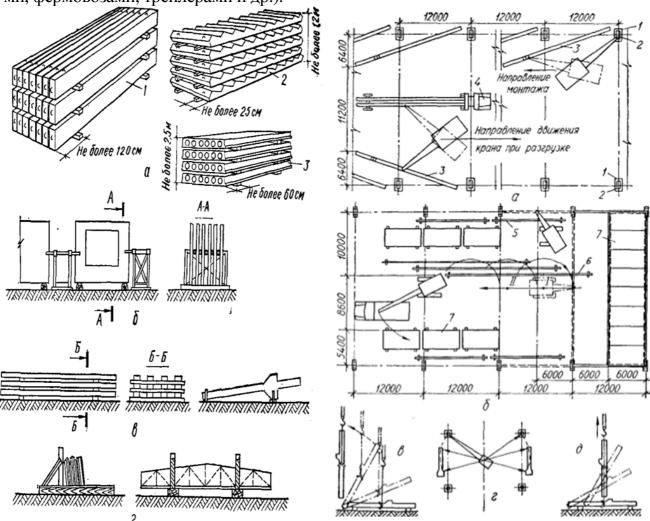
Схемы складирования конструкций: а — складирование в штабелях; б— стеновых панелей в кассетах; в — колонн плашмя и на ребро; г — ферм; 1 — ригеля; 2 — лестничные марши; 3 — многопустотные панели. Конструкции рекомендуется хранить в штабелях в положении, близком к проектному (рис. хранить плашмя, а стеновые панели удобнее всего вставлять в специальные кассеты (рис. 1, б)
